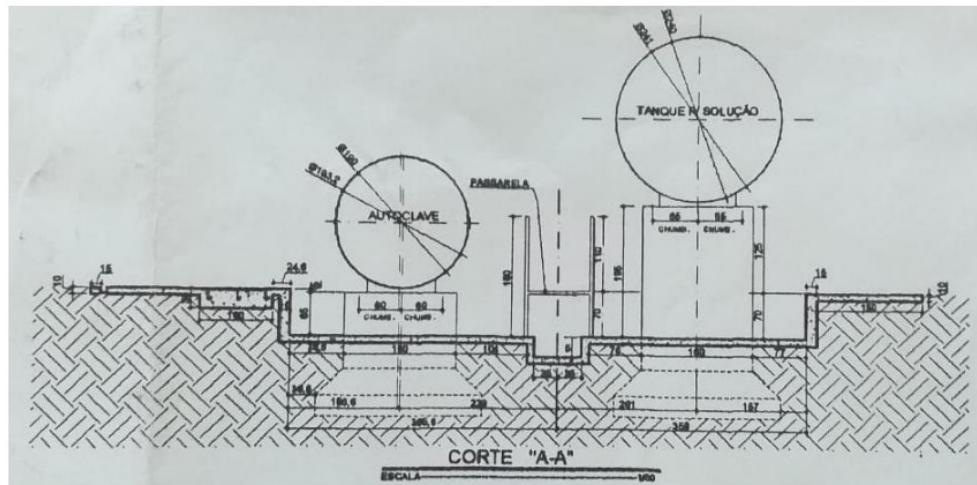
Planta referente ao fosso de contenção de vazamentos. - Fonte: RADA
